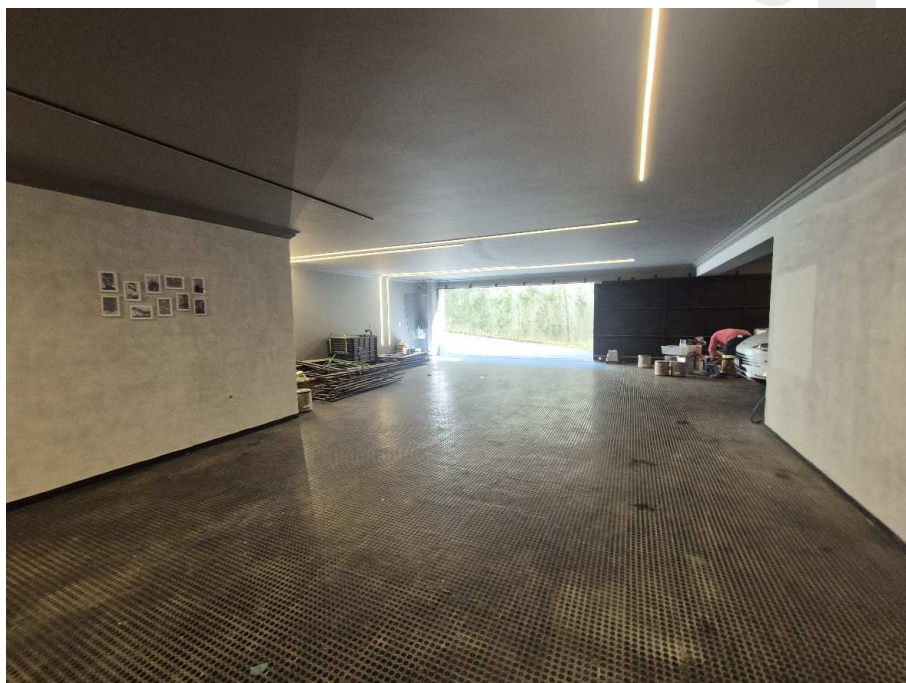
Acesso ao pavimento inferior do imóvel avaliado.
